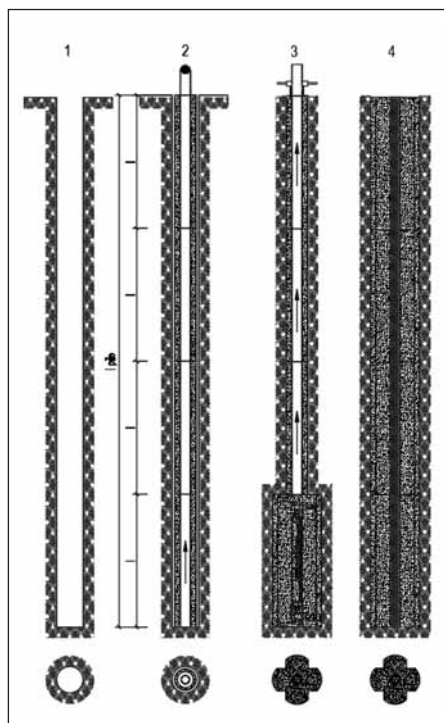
Схема строительства: 1 – модульные железобетонные трубы; 2 – скважинное заполнение; 3 – комбинация приборов и арматурных свай; 4 – модуль сваи буронабивной
